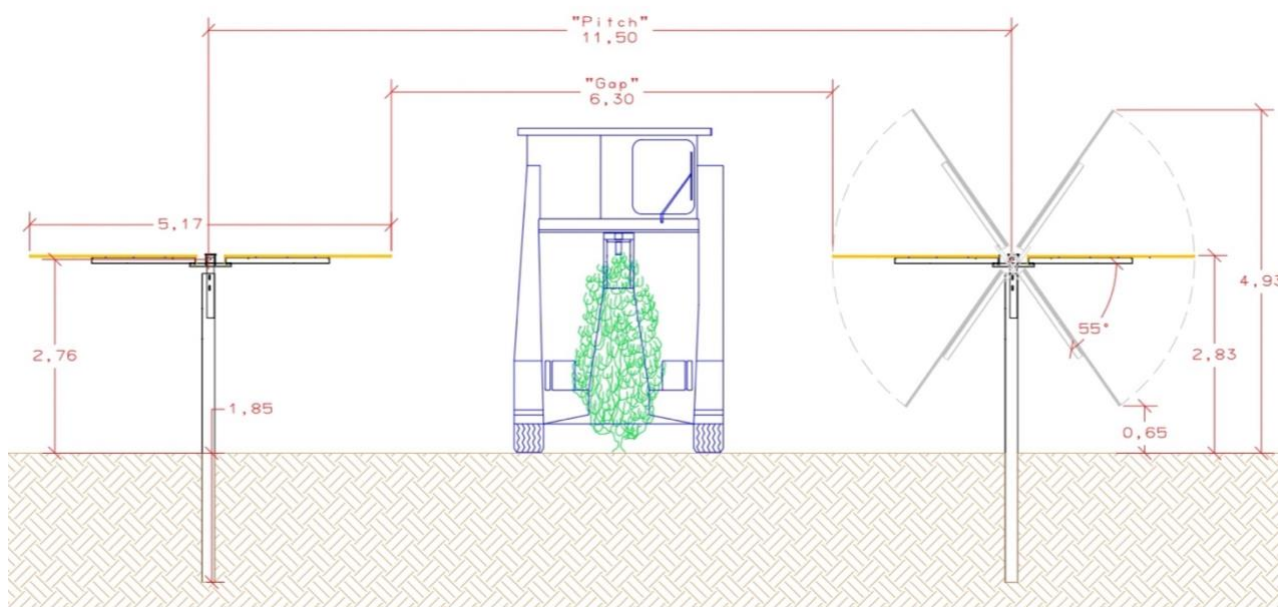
Particolare della sezione trasversale con macchina scavallatrice per la raccolta delle olive.
